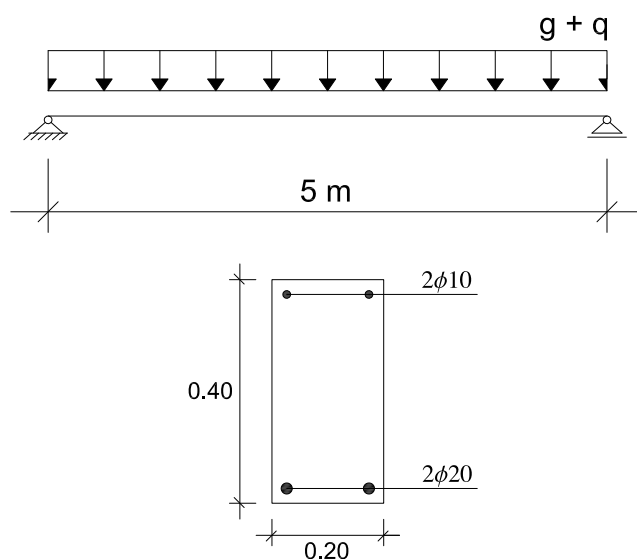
Viga de betão armado simplesmente apoiada e a sua secção transversal
